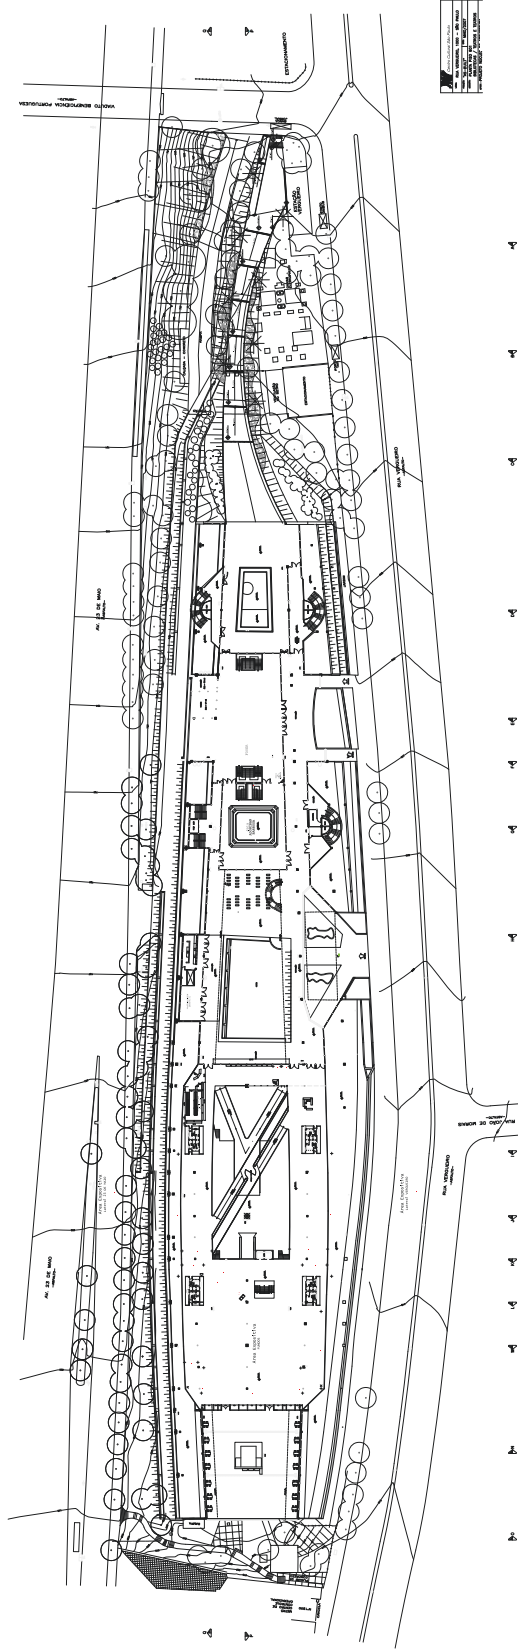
Grundriss Erdgeschoss (Innere Straße)
